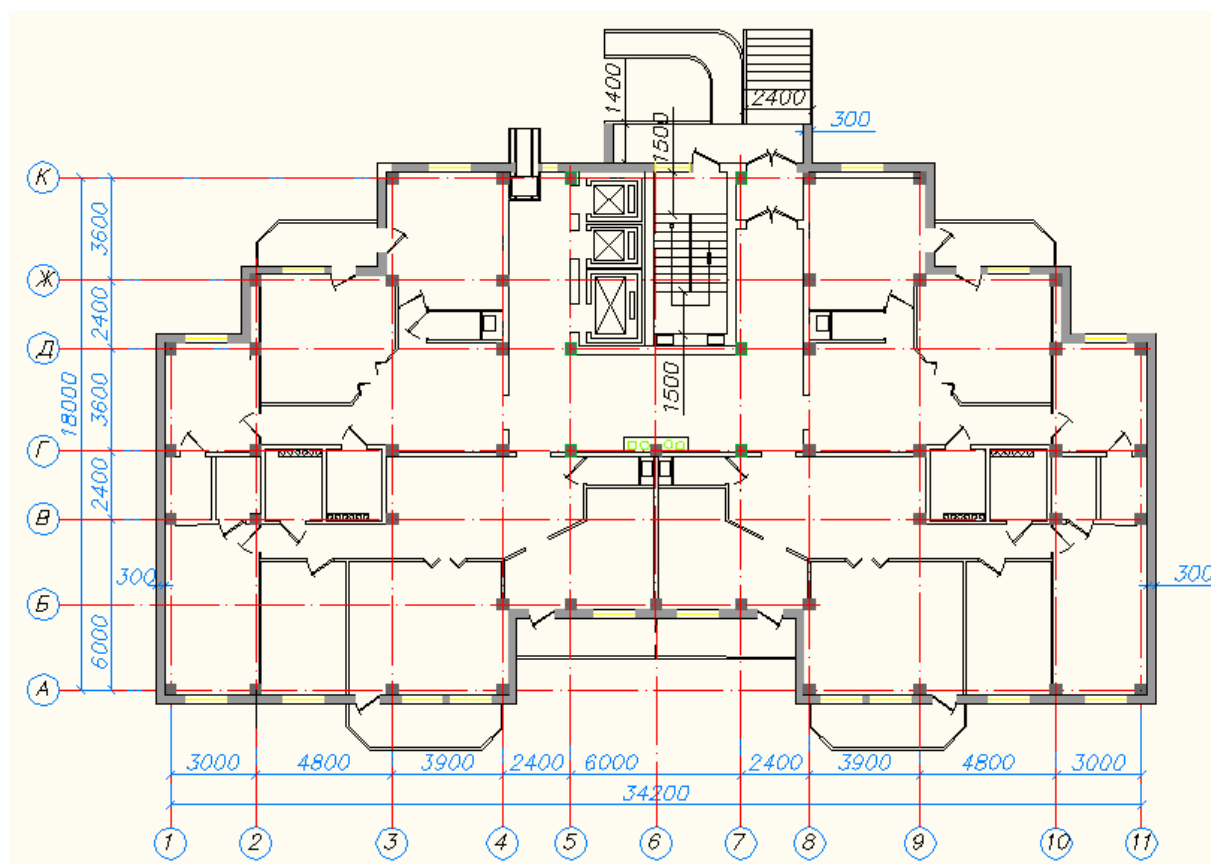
План типового этажа каркасно-панельного 22-этажного здания
